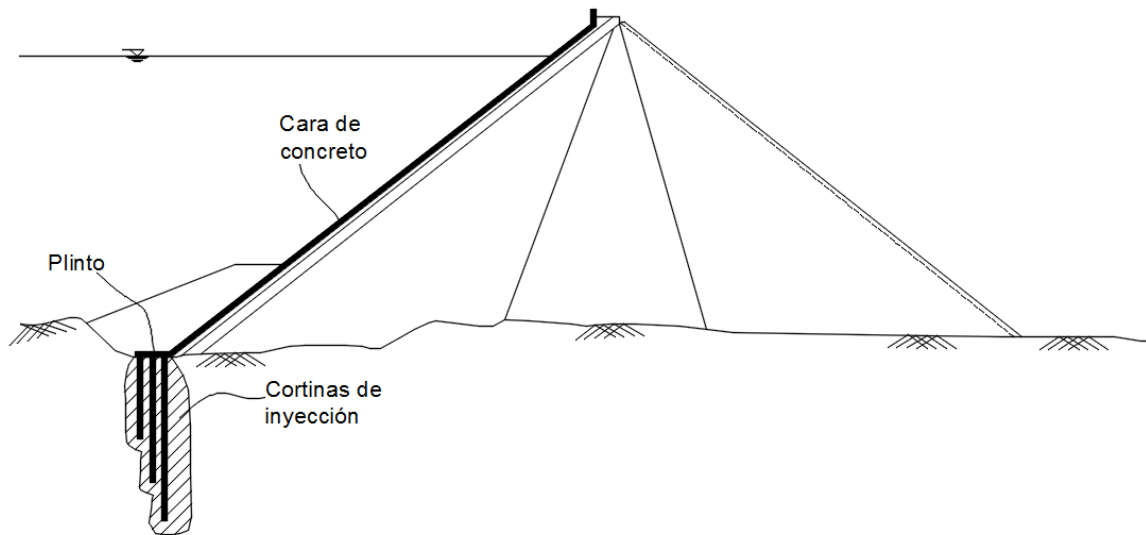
Cortinas de inyección en el plinto de una presa de enrocado con cara de concreto.
